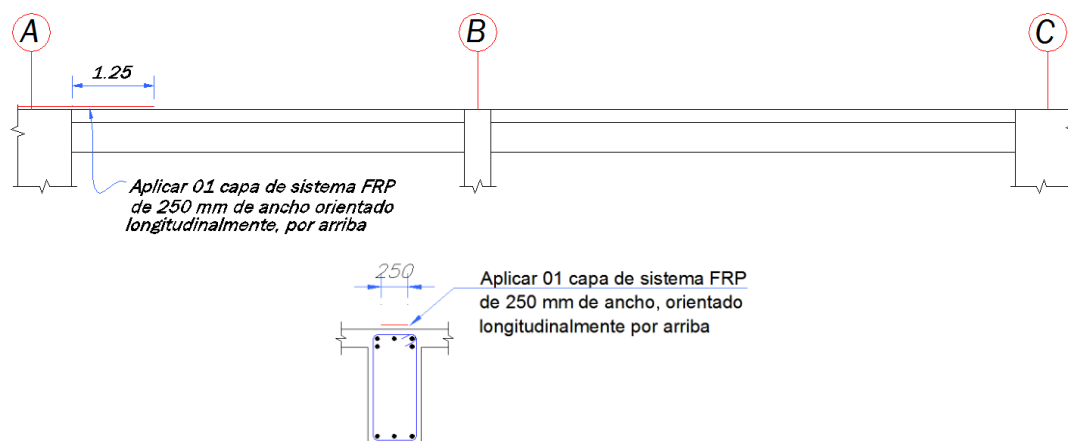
Solución 01 – Elevación y Sección transversal del diseño del refuerzo en la zona negativa de viga.
